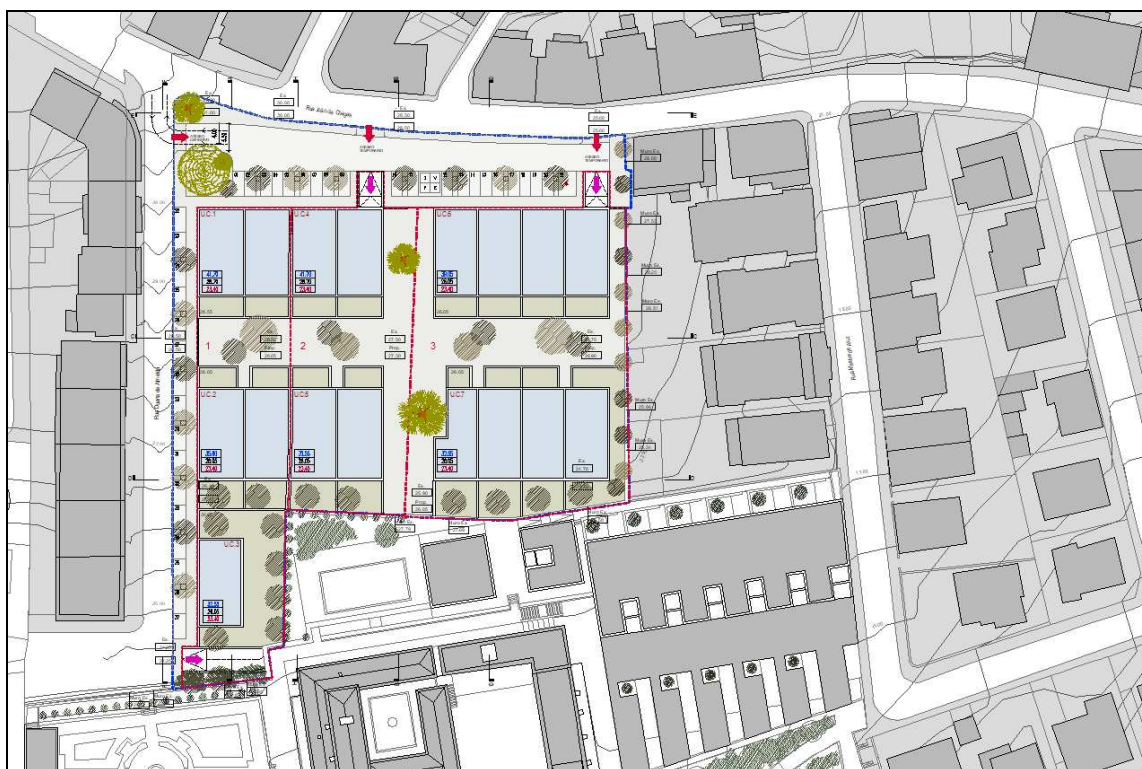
Planta de implantação do loteamento (fonte: pedido de informação prévia)
